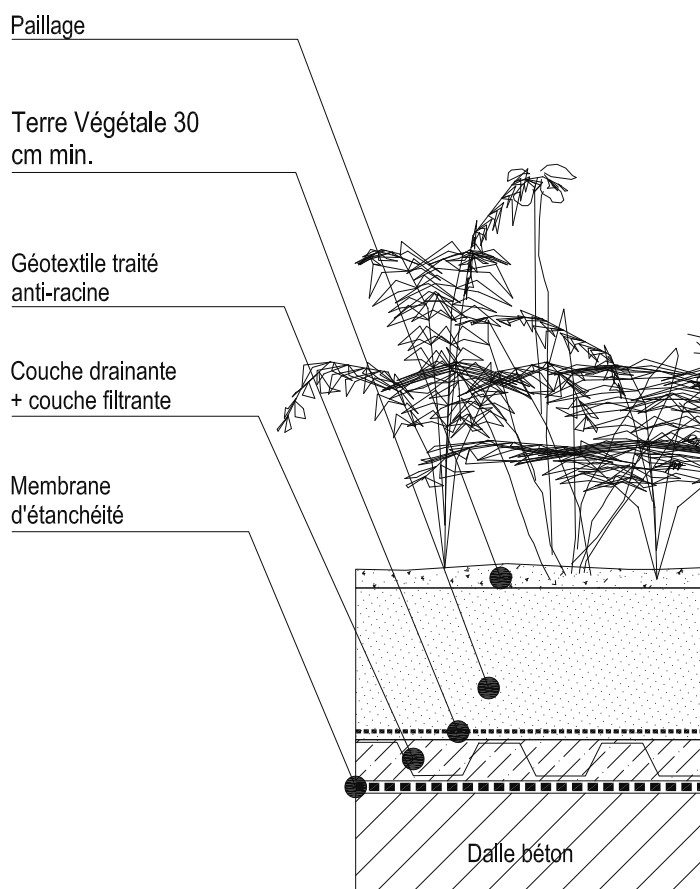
Profil technique de la structure mise en œuvre pour permettre la plantation sur dalle
